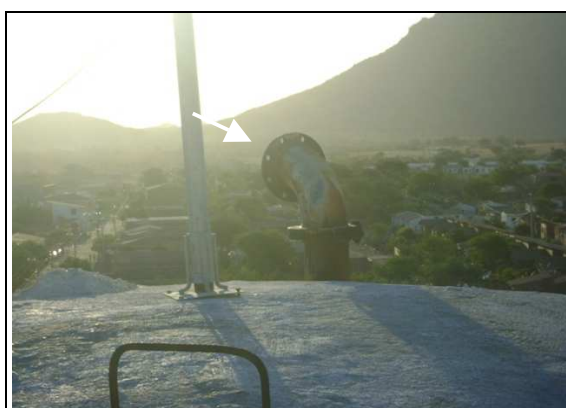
REL-01: Tubulação de ventilação inadequada.
